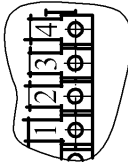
Расположение клеммной колодки X1 для подключения кабелей внутри корпуса ПУА. Маркировка клемм для внешних подключений – вид Б
